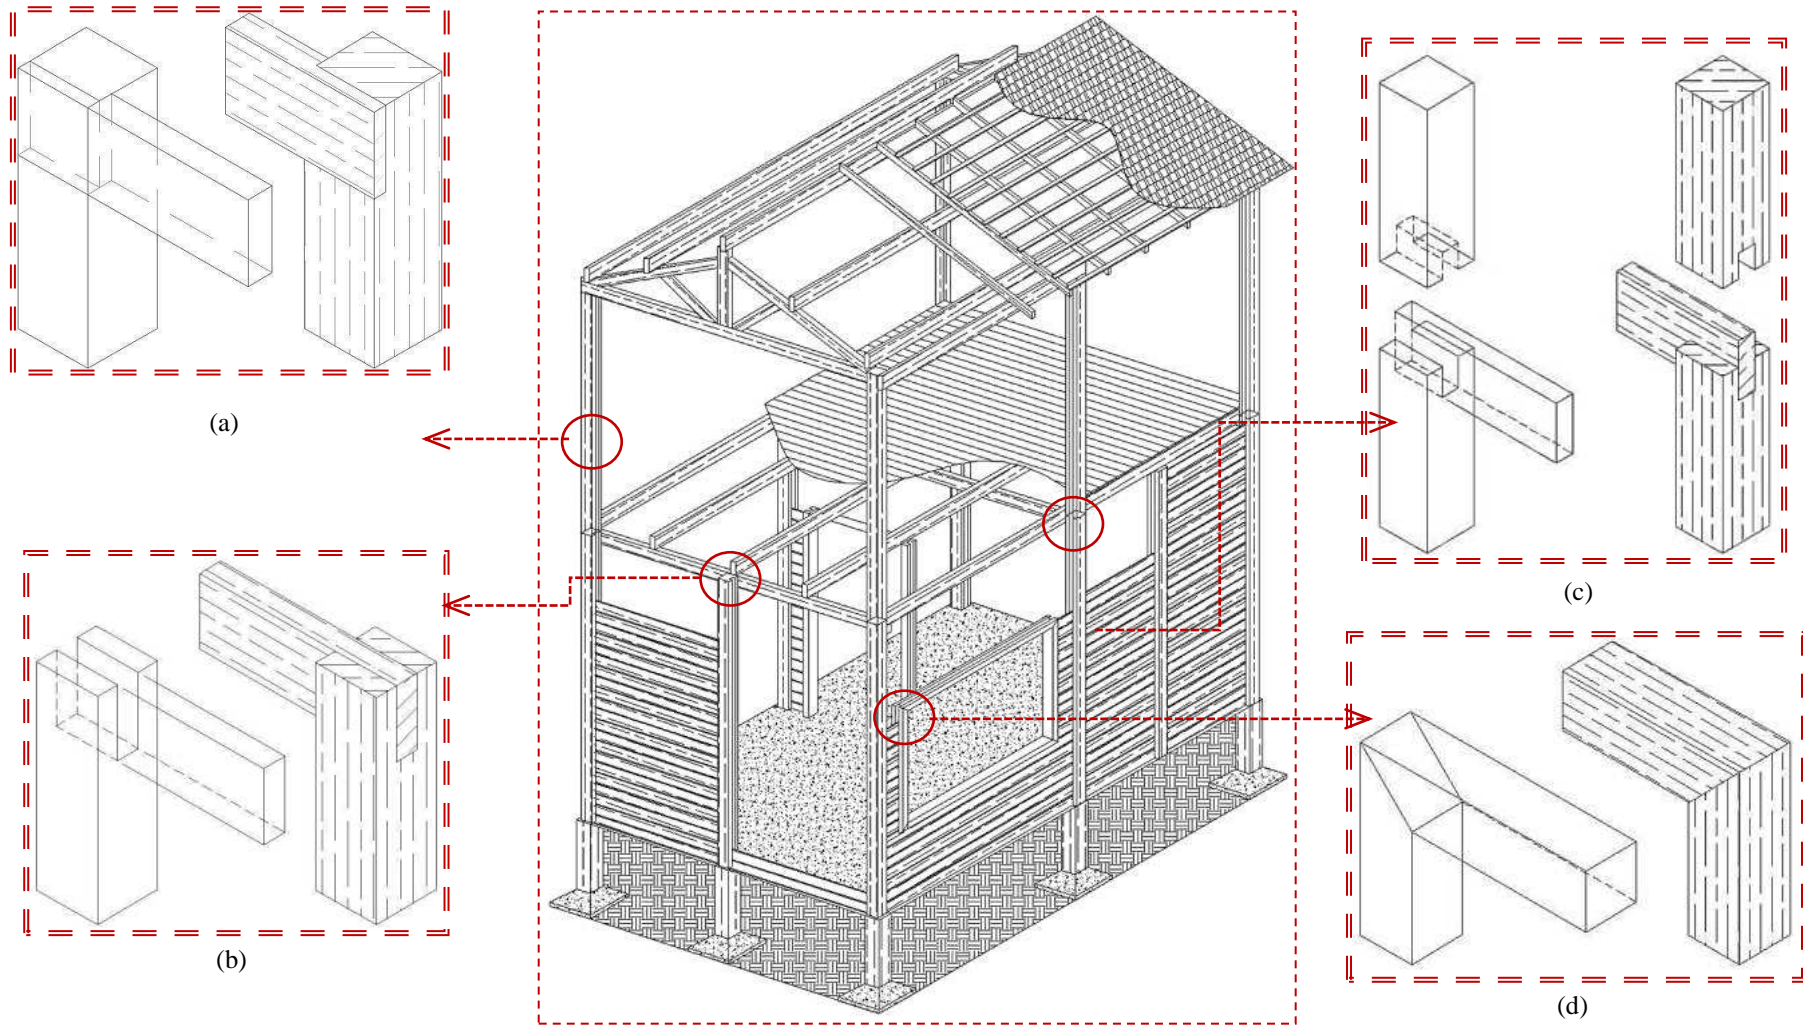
Sistema construtivo viga-pilar e detalhes de ligações segundo a rigidez: (a; c; d) semirrígida; (b) rígida.
